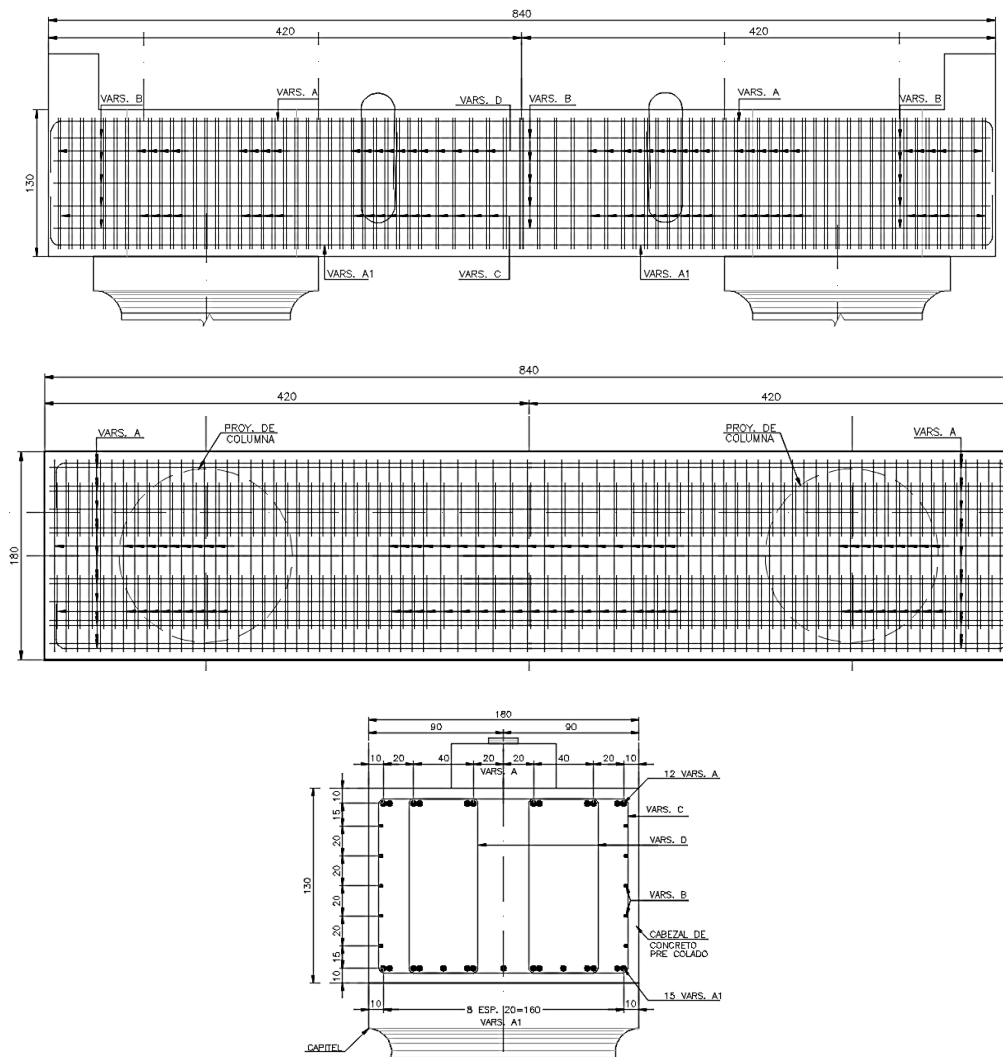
Dimensiones y armado de cabezal en apoyo extremo.
